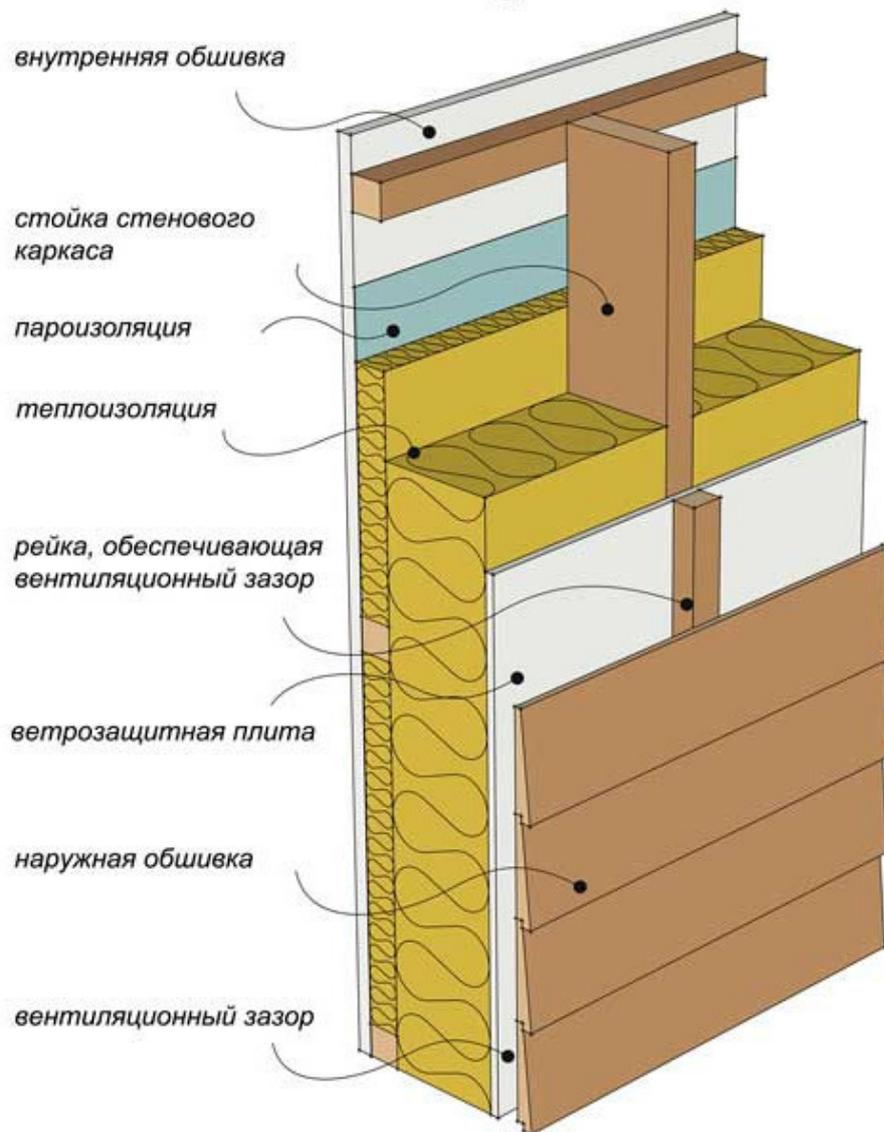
Легкая наружная стена из деревянного каркаса с горизонтальной наружной обшивкой из вагонки
